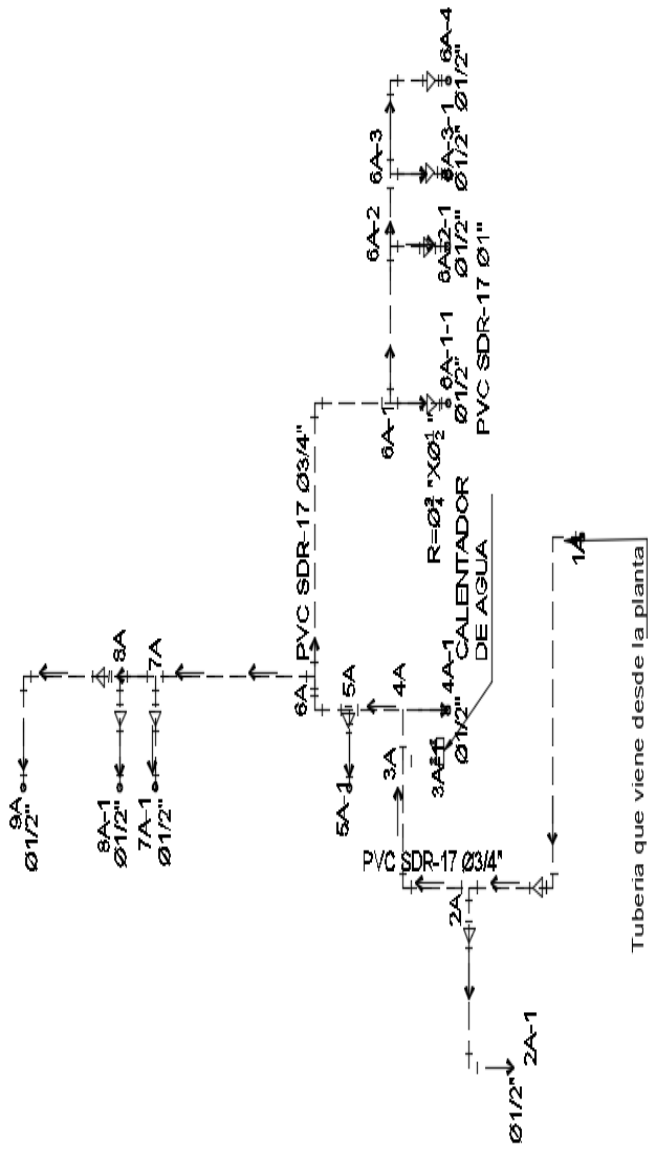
Red interna de las plantas 4 y 5 del apartamento A
